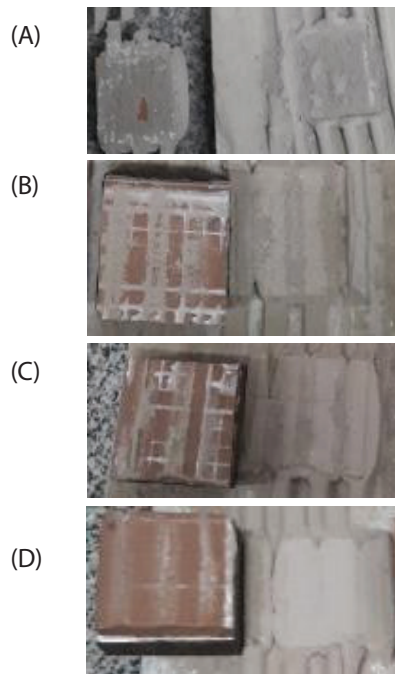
Tipos de ruptura dos ensaios de aderência à tração, para resíduo RM: (a) argamassa padrão, (b) argamassa RM10, (c) argamassa RM15 e (d) argamassa RM20.
